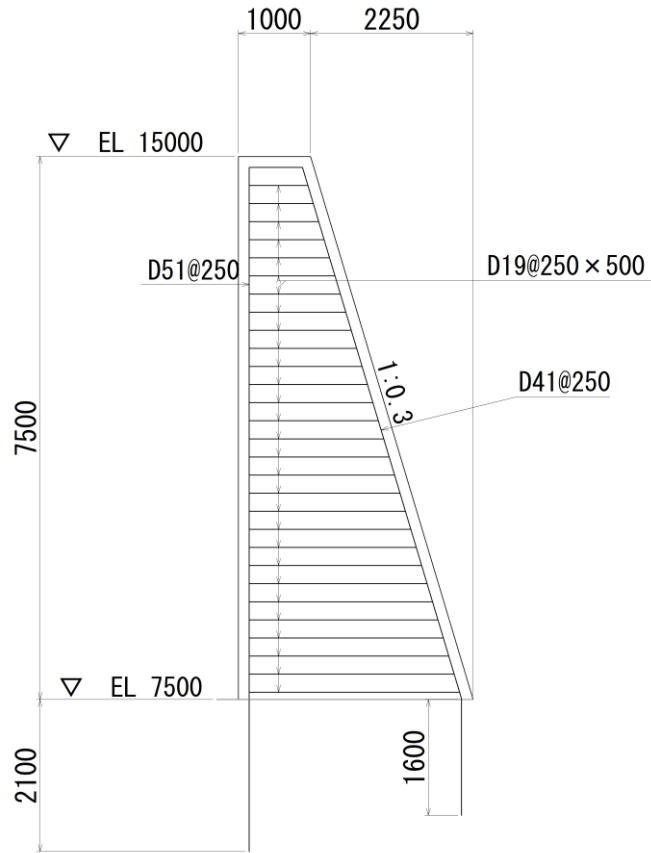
防波壁（波返重力擁壁）の概略配筋図（⑤-⑤断面）
